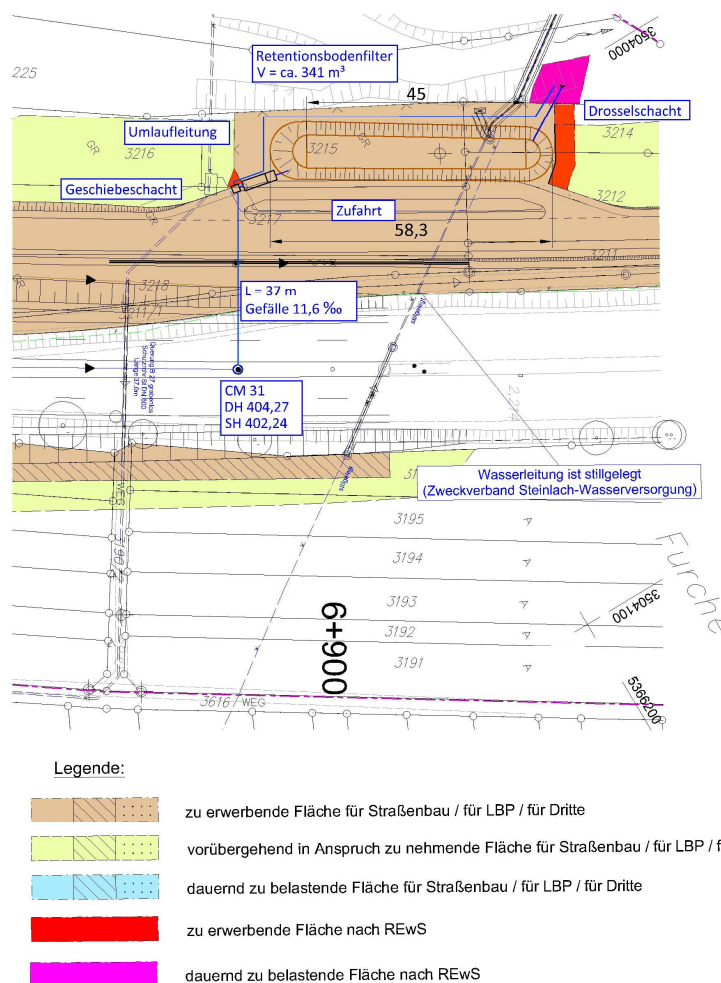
Entwässerungsabschnitt 3: Grundriss Retentionsbodenfilteranlage. Ohne Maßstab
